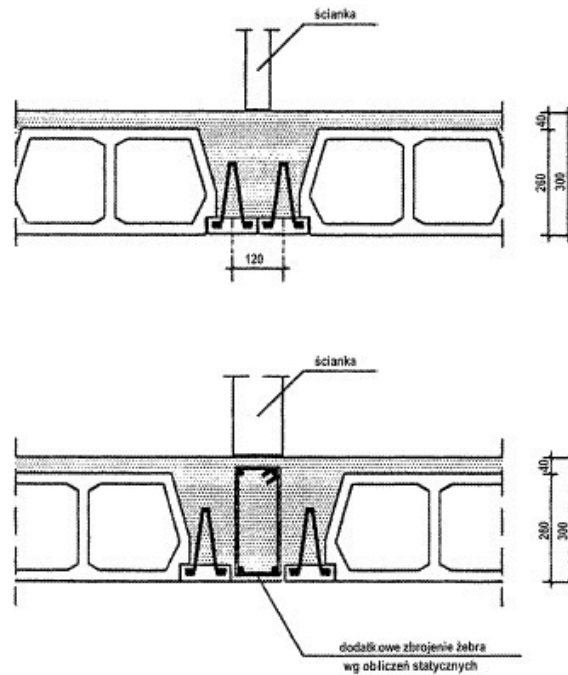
Przykład przekroju przez żebro rozdzielcze.
